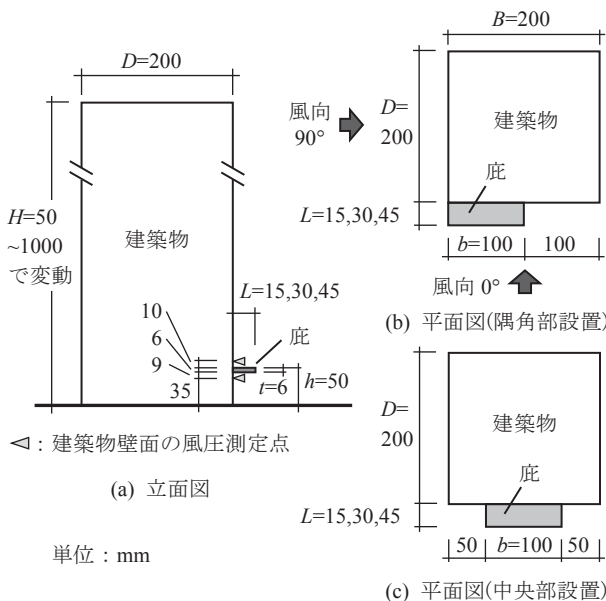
風洞実験模型の詳細 (立面図および平面図) (Details of Wind Tunnel Test Models)
